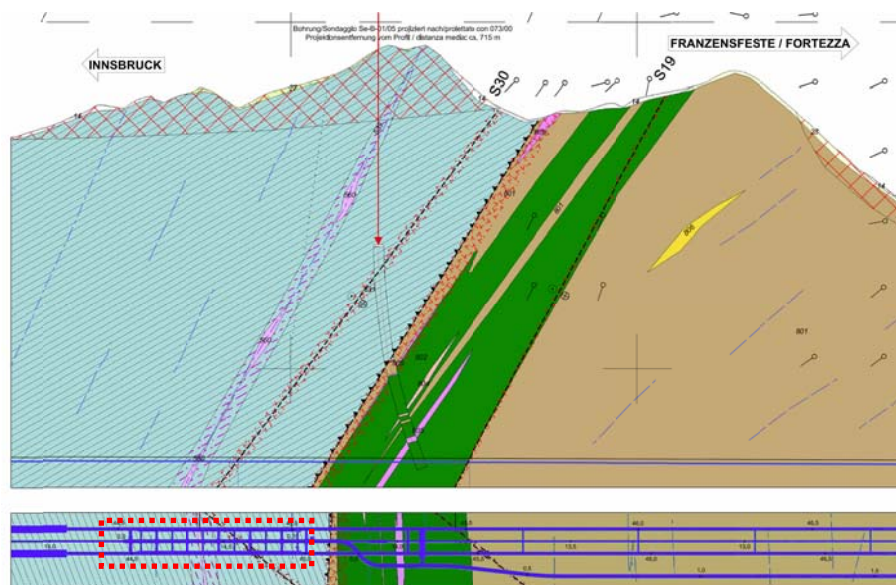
Auszug aus dem geomechanischen Längsschnitt und aus dem geologischen Lageplan [3] mit Angabe des untersuchten Bereichs.
